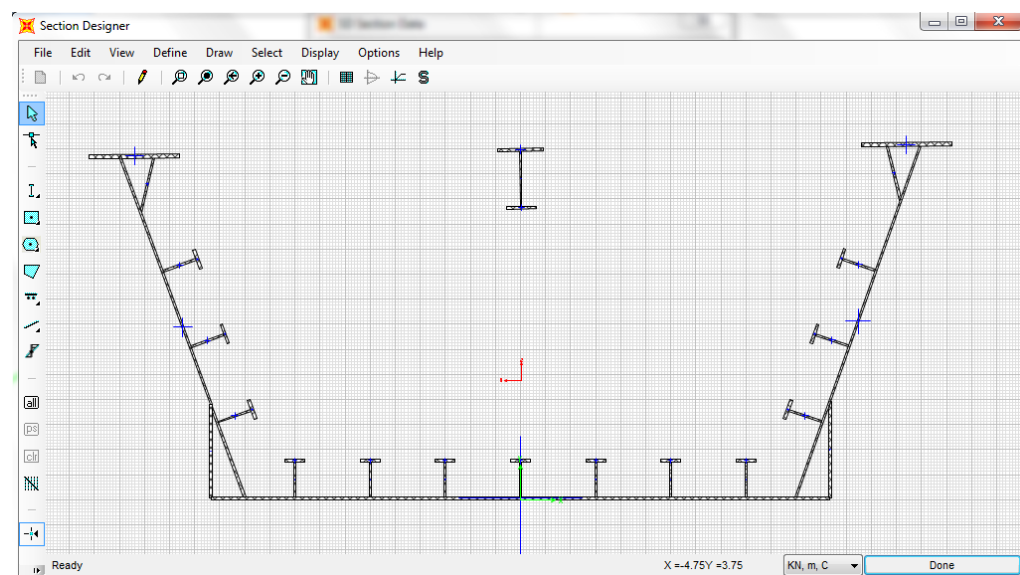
Modelo 1 en SAP2000, ingreso de la sección cajón metálica, como viga de pico de lanzamiento de la superestructura del puente durante la etapa de lanzamiento
